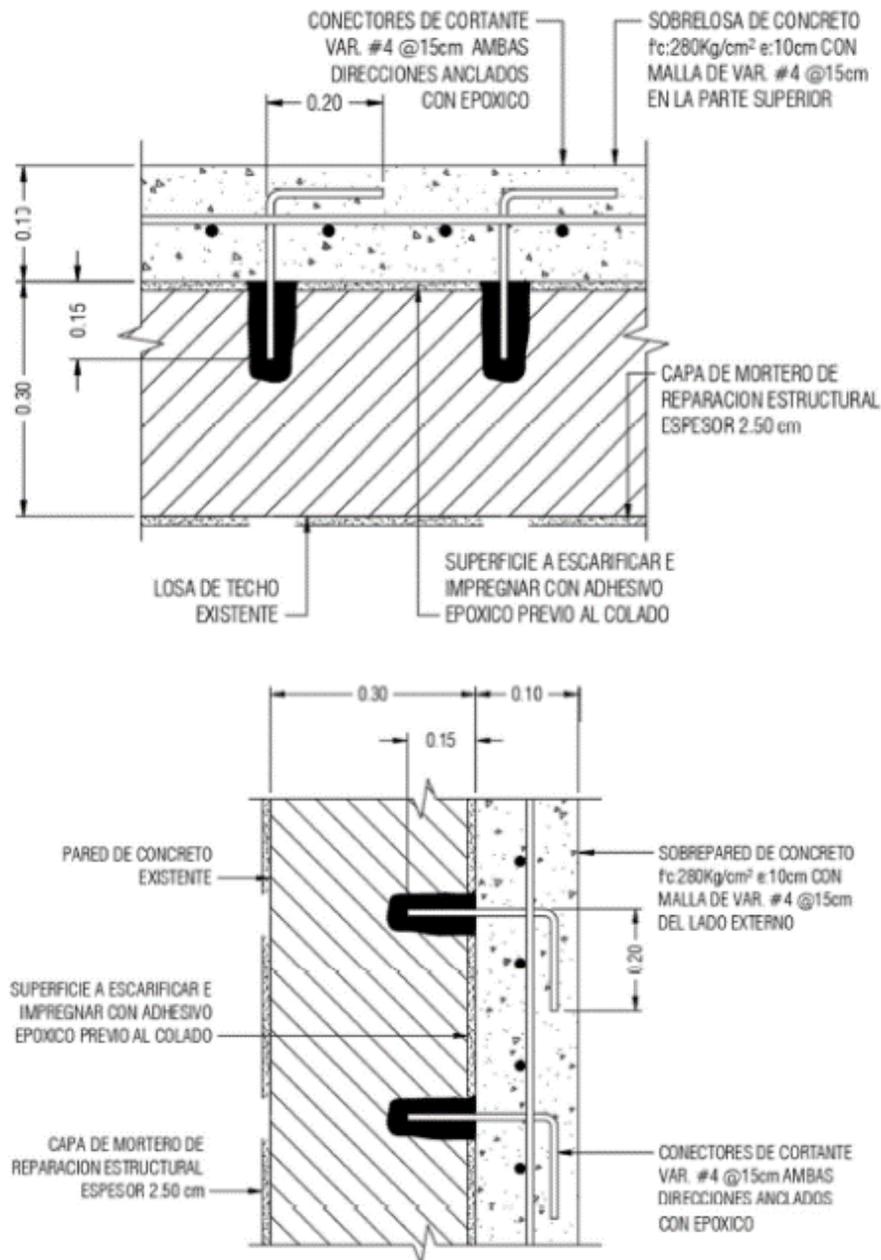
Detalles de refuerzo externo propuesto por empresa constructora para losa y paredes.
